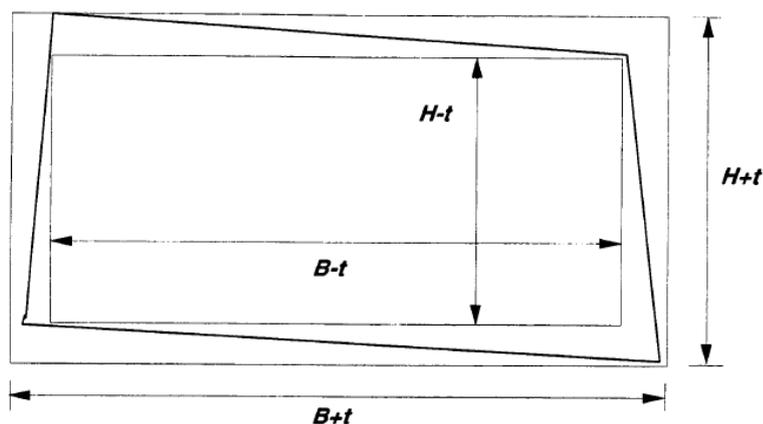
Toleranzen für die Maße von rechteckigen Scheiben
